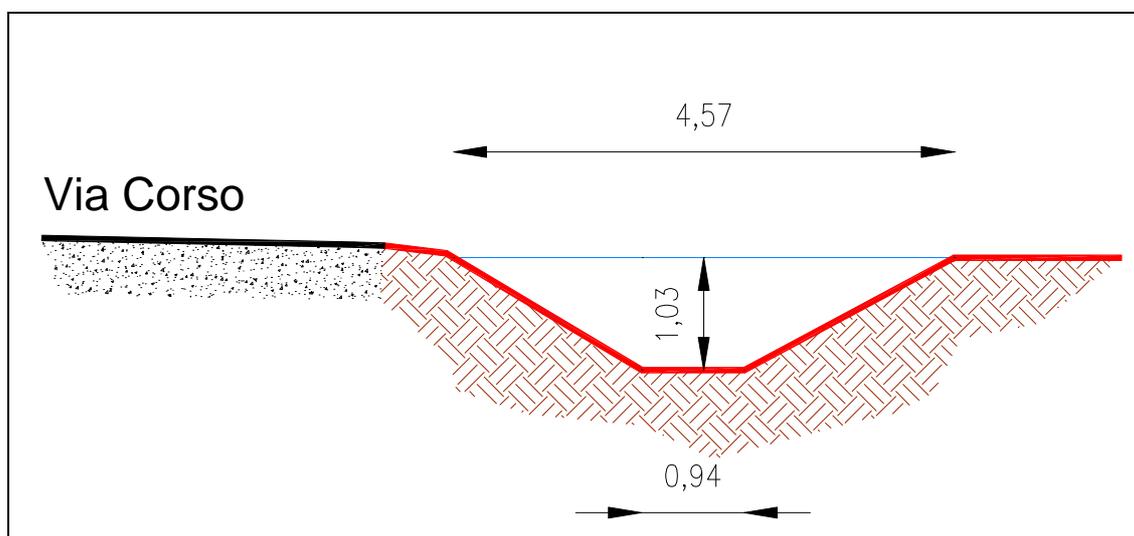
Canale Mestrina Vecchia – Sezione tipo in prossimità dell'ambito d'intervento
